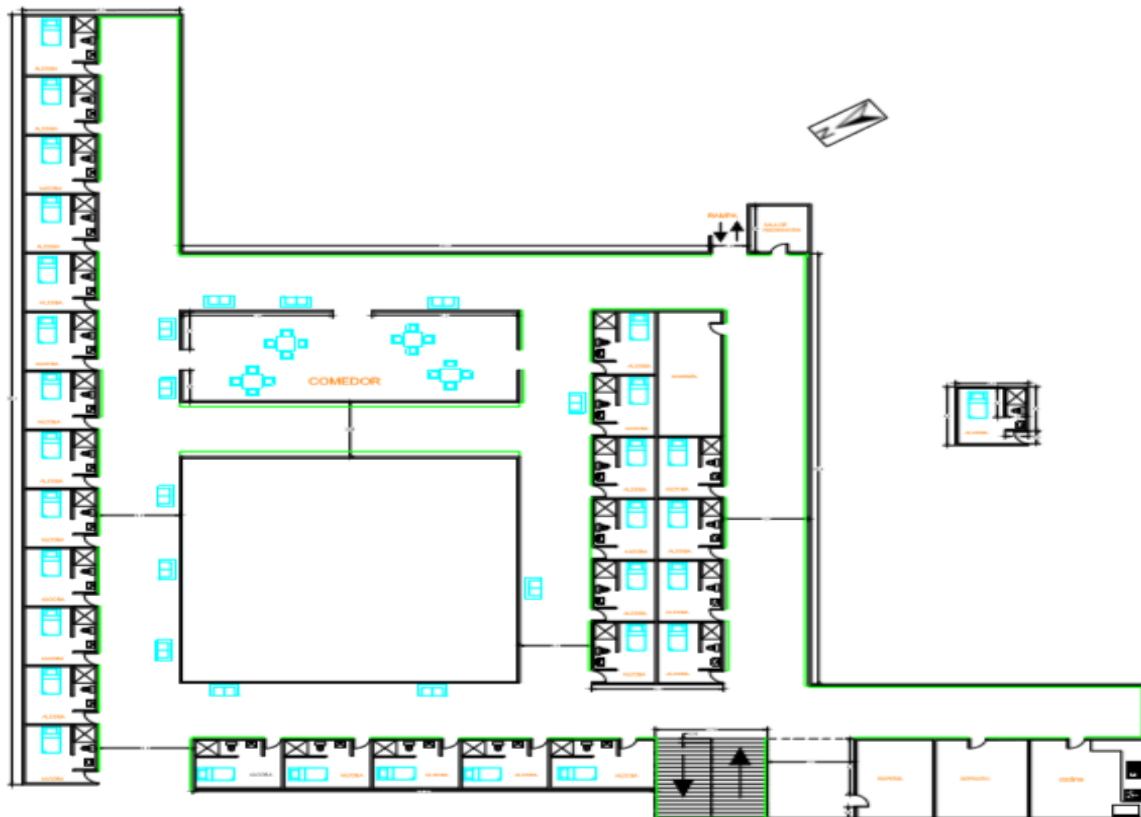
Plano con las modificaciones planteadas en el pabellón María Inmaculada
